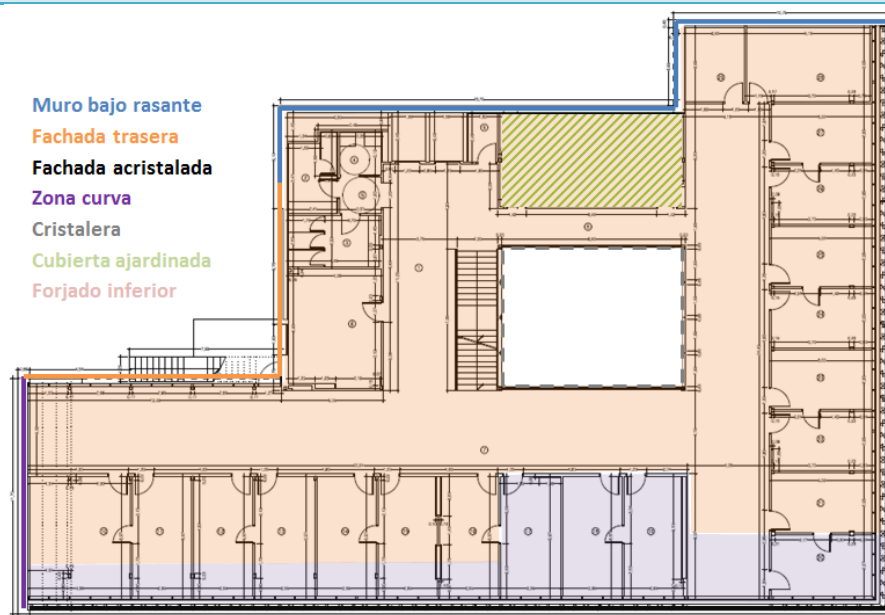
localización de cada cerramiento de la primera planta en plano acotado.
